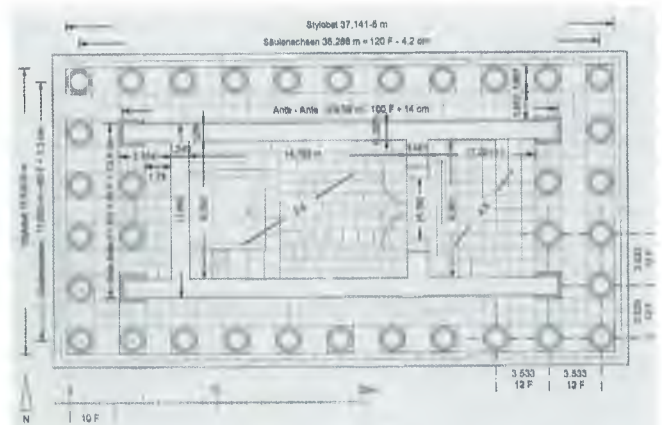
Grundriss, Hauptmaße und Proportionen. M. 1 : 300
